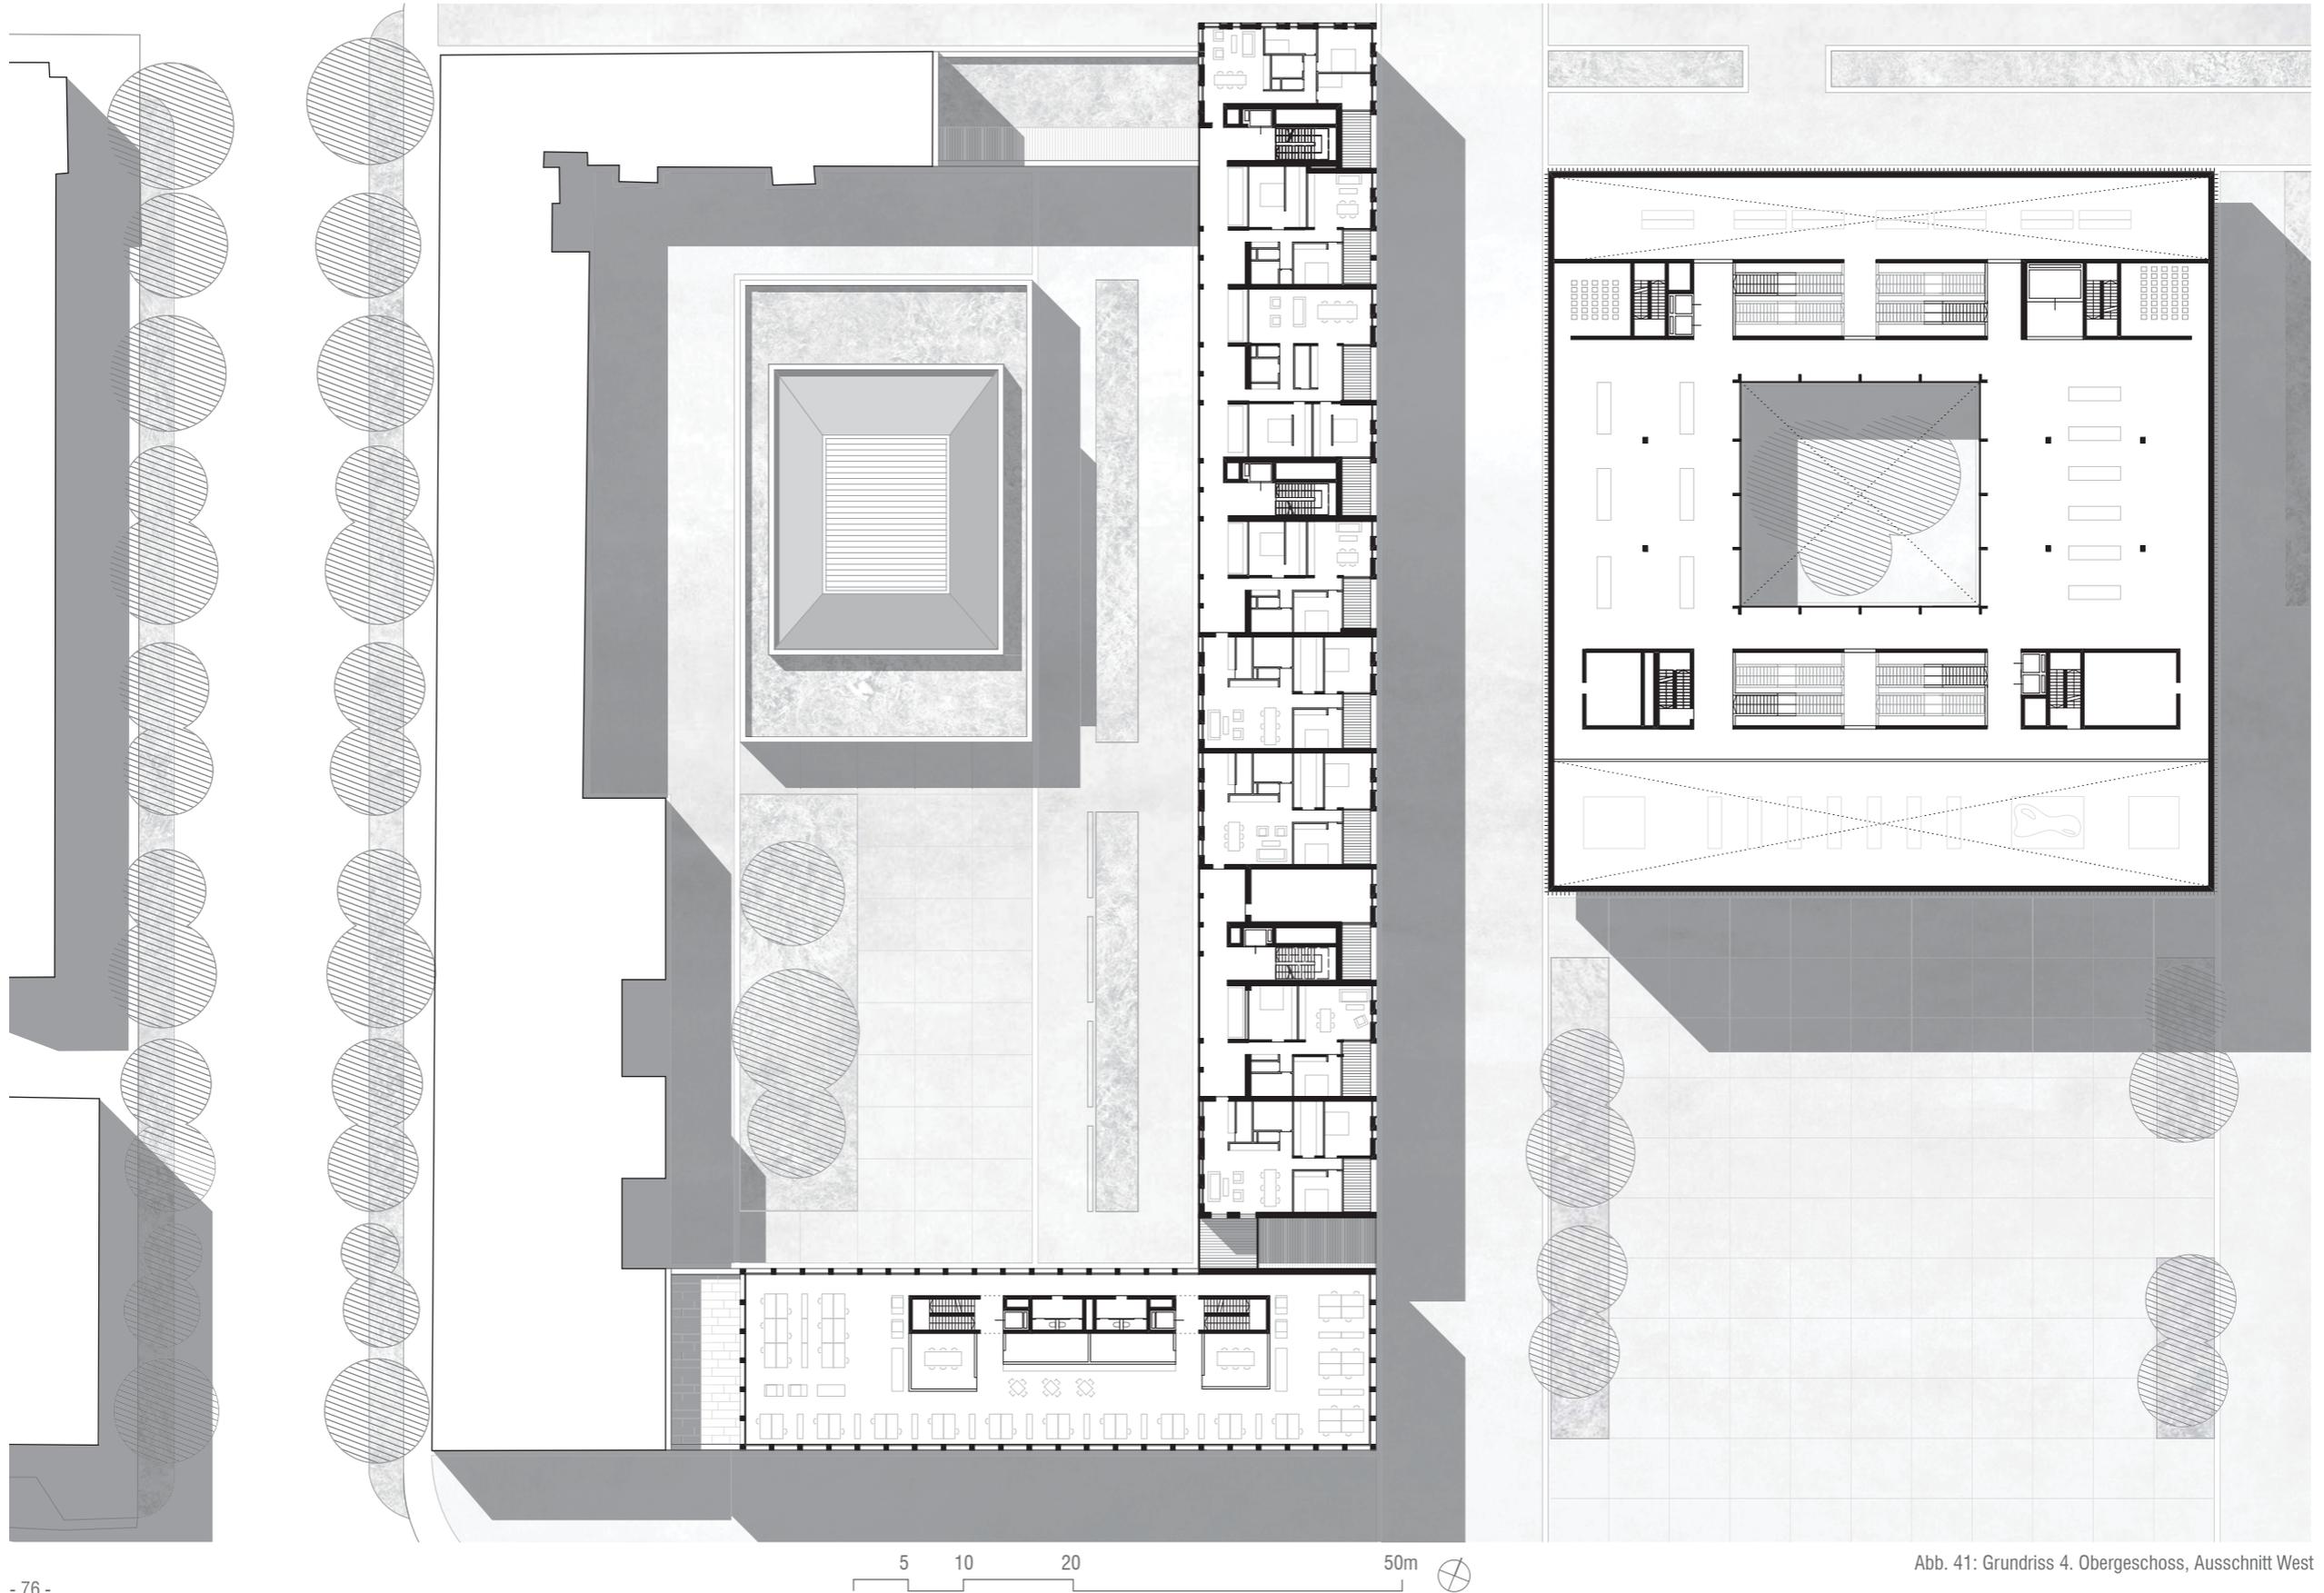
Grundriss 4. Obergeschoss, Ausschnitt West
